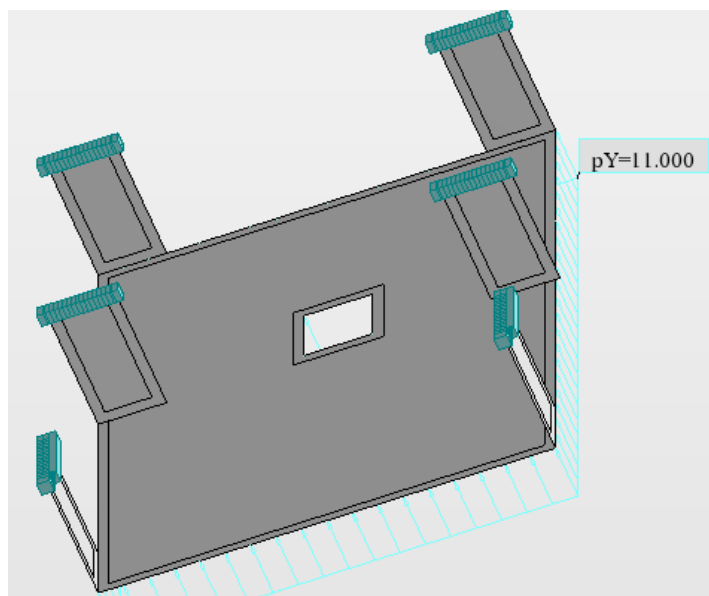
Vista inferior do esquema estrutural nos apoios.
